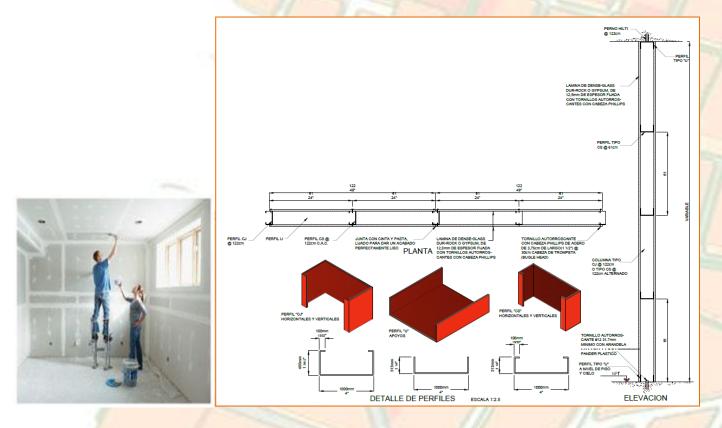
Sistema constructivo de muro seco considerado en la propuesta. Fuente: propia.
